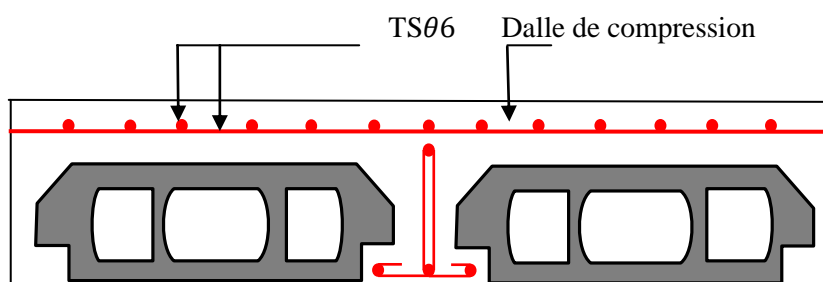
Schéma de ferrailage de la dalle de compression.
